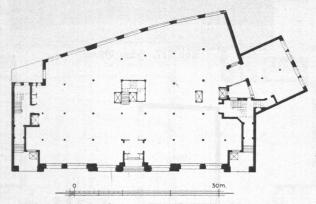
Geschäftshaus Wm. Rlöpper, Grundrig.
